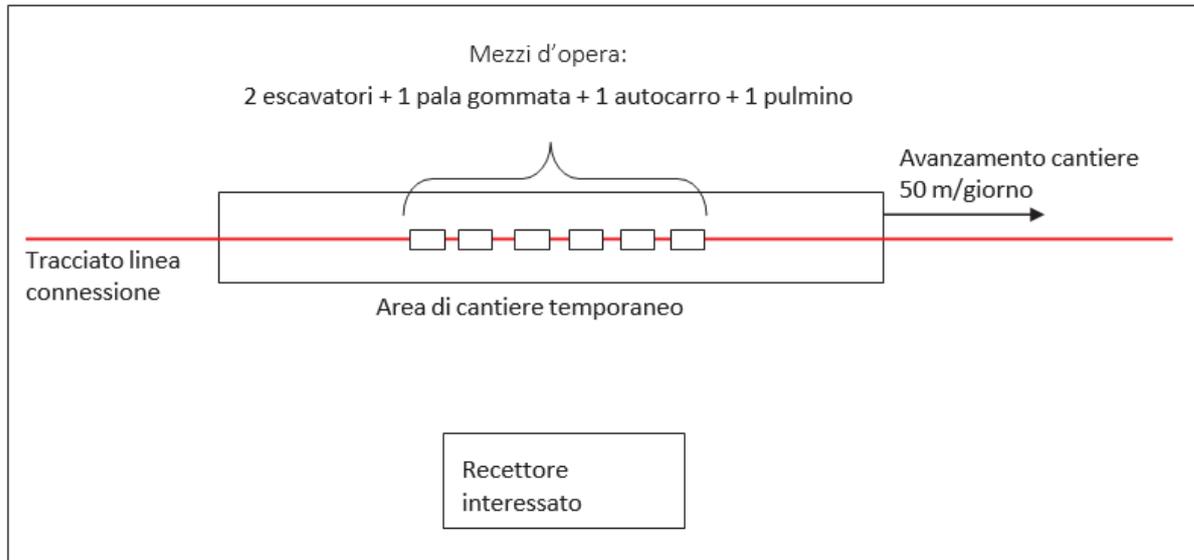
Rappresentazione schematica dell'area di cantiere durante le lavorazioni
